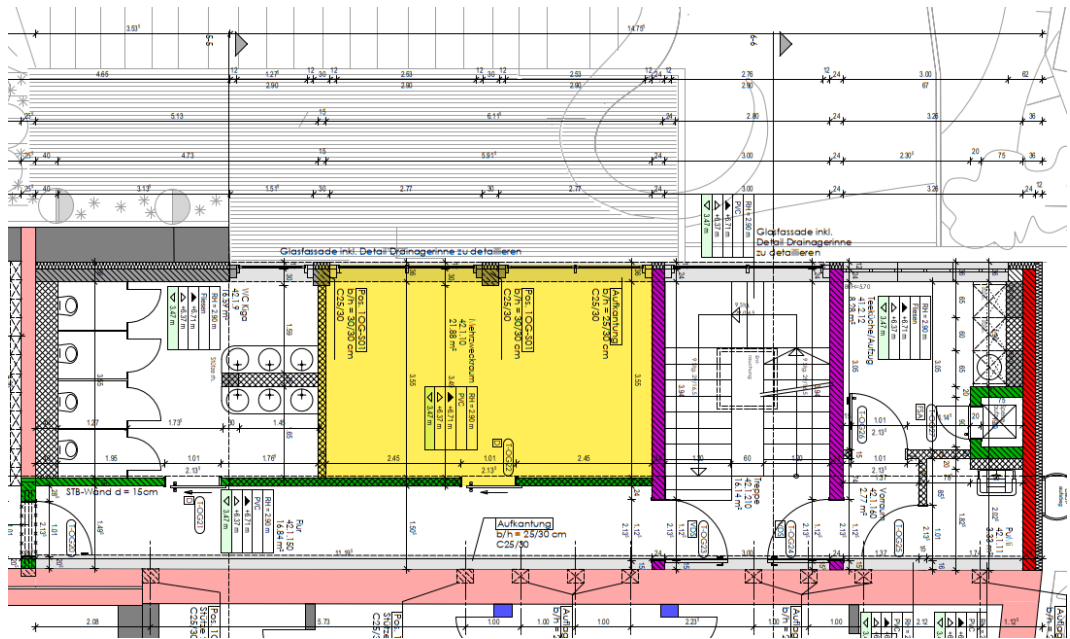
Grundriss 1. OG mit untersuchtem Raum (gelb).
